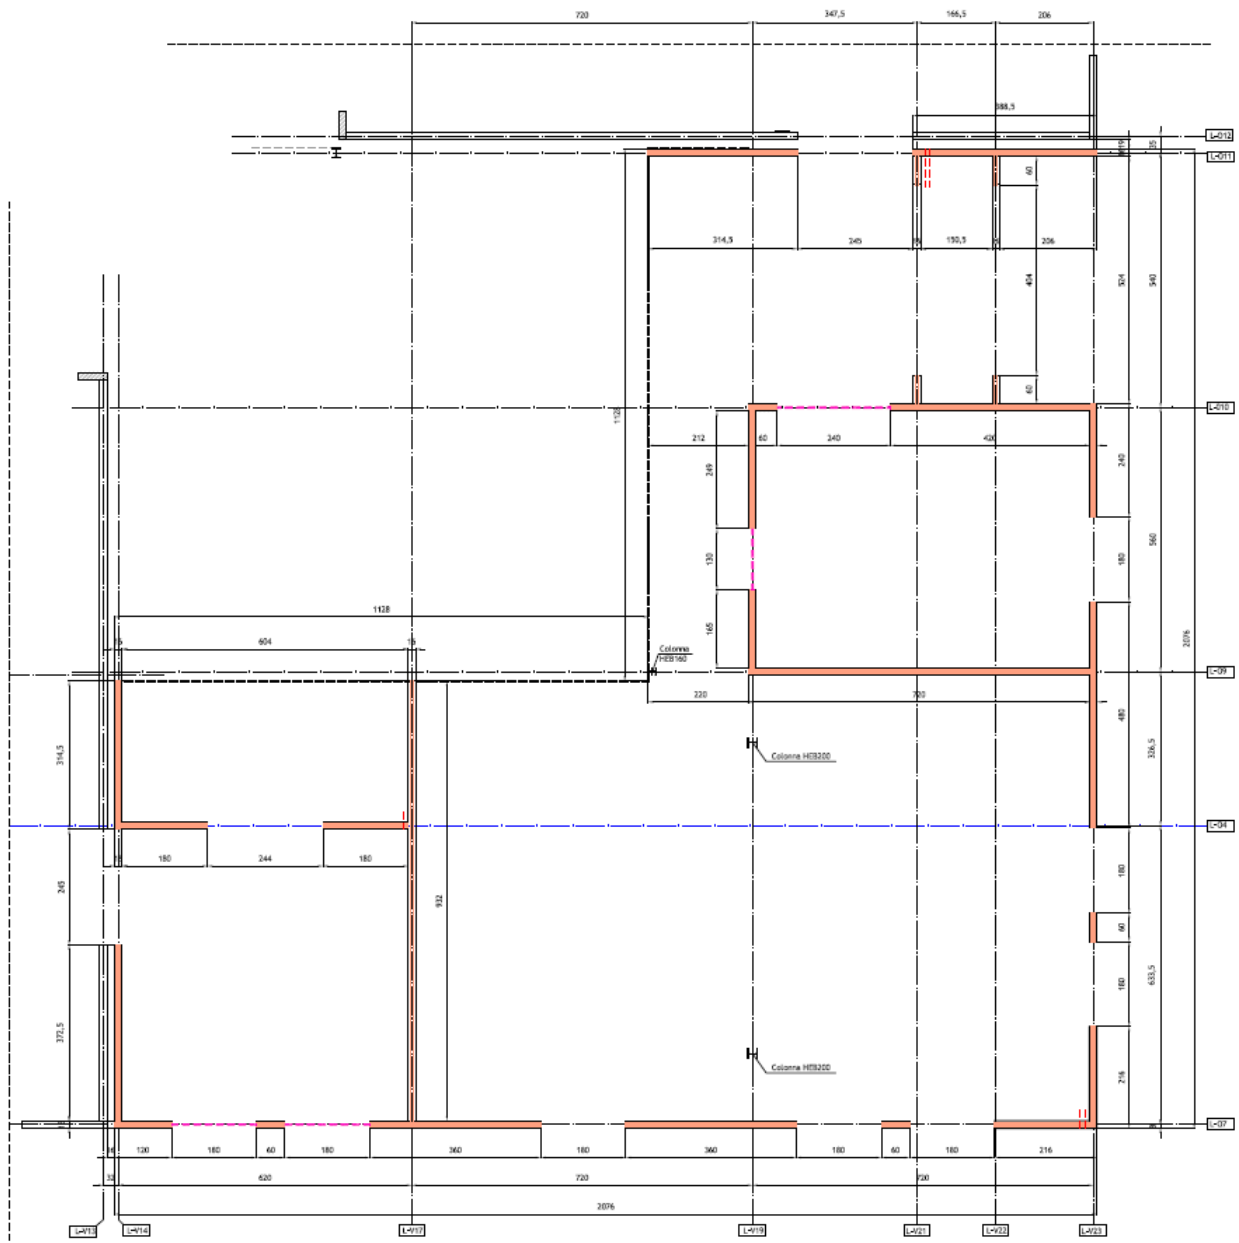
US 02-L planimetria piano terra porzione in X-lam
